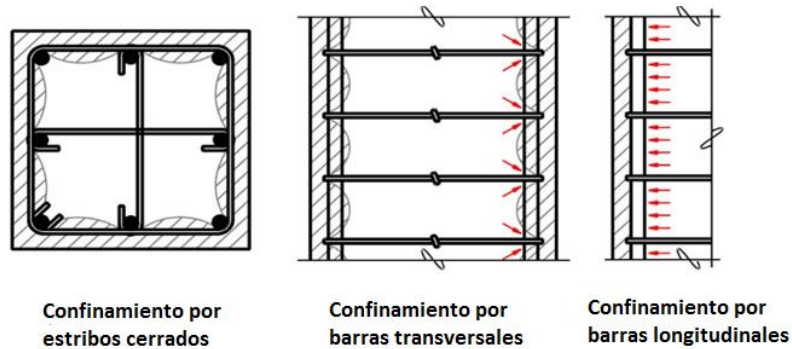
Refuerzo transversal y zonas del concreto confinado y no confiando (FEMA 451, 2006).
